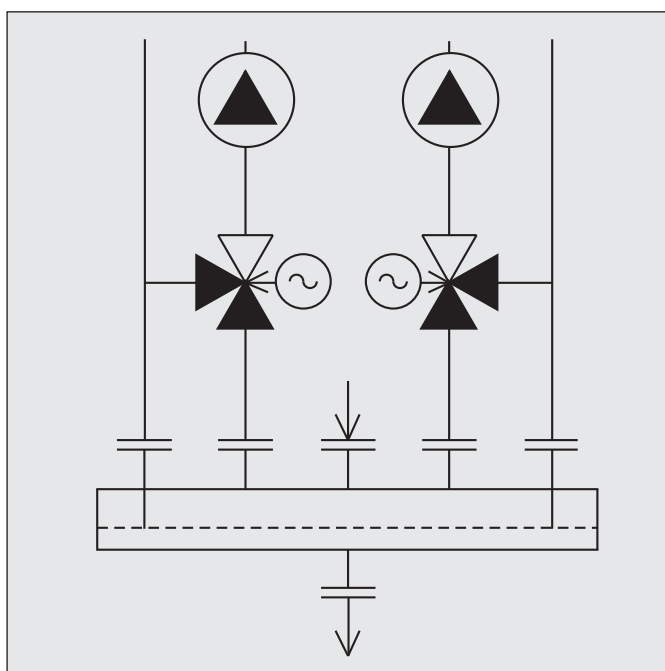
Hlavní přívod na kraji, první zpátečka do spodní komo-ry – správné zapojení
